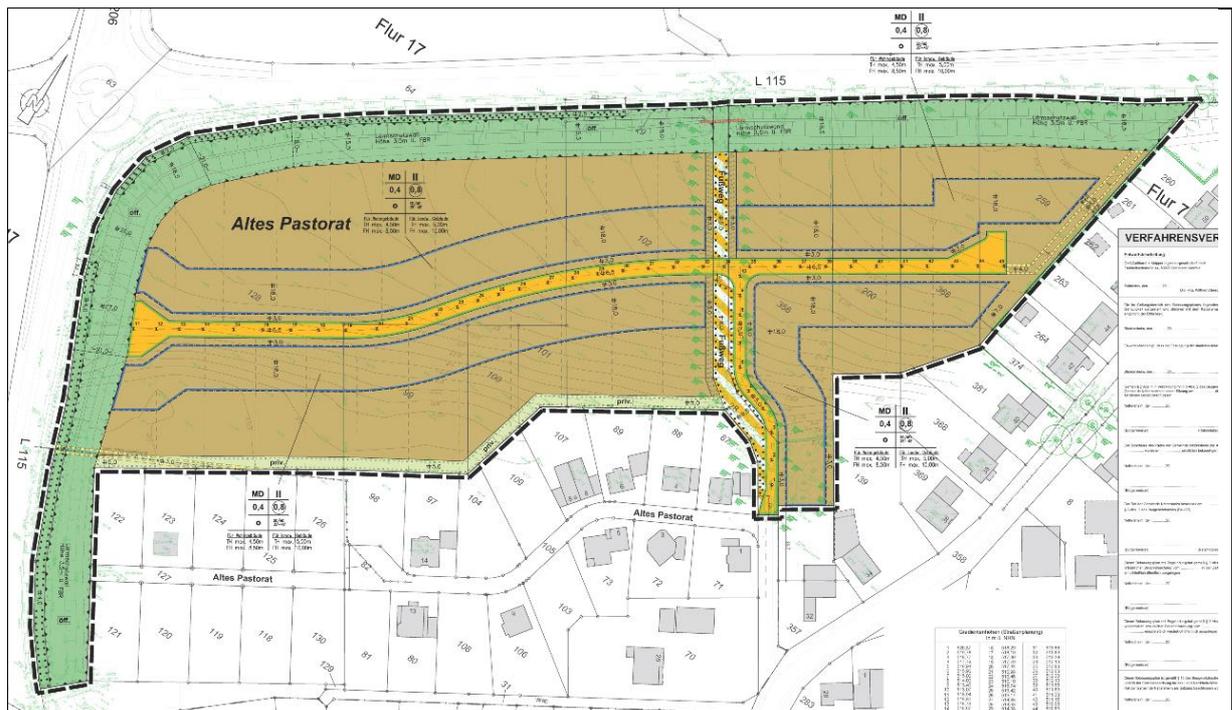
Planzeichnung des Bebauungsplans (Auszug)
